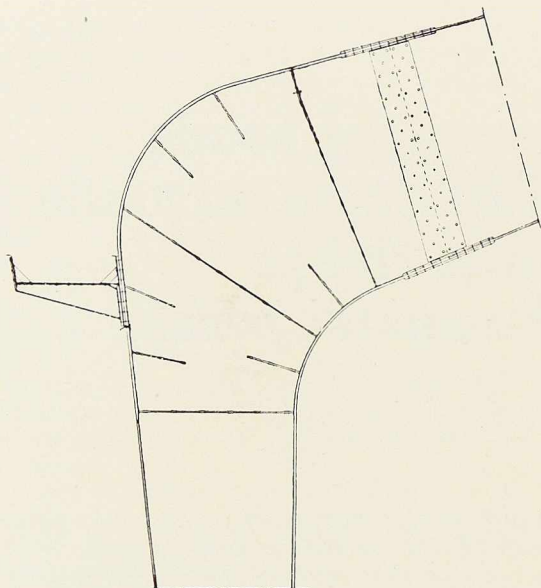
Détail montrant la transition entre la poutre et la béquille du portique.
